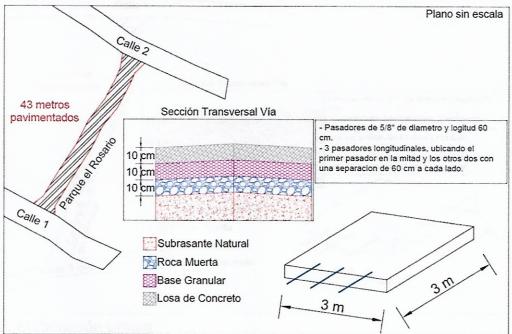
Plano y sección transversal calle 10 sur entre diagonal 9 sur y carrera 8 sur
